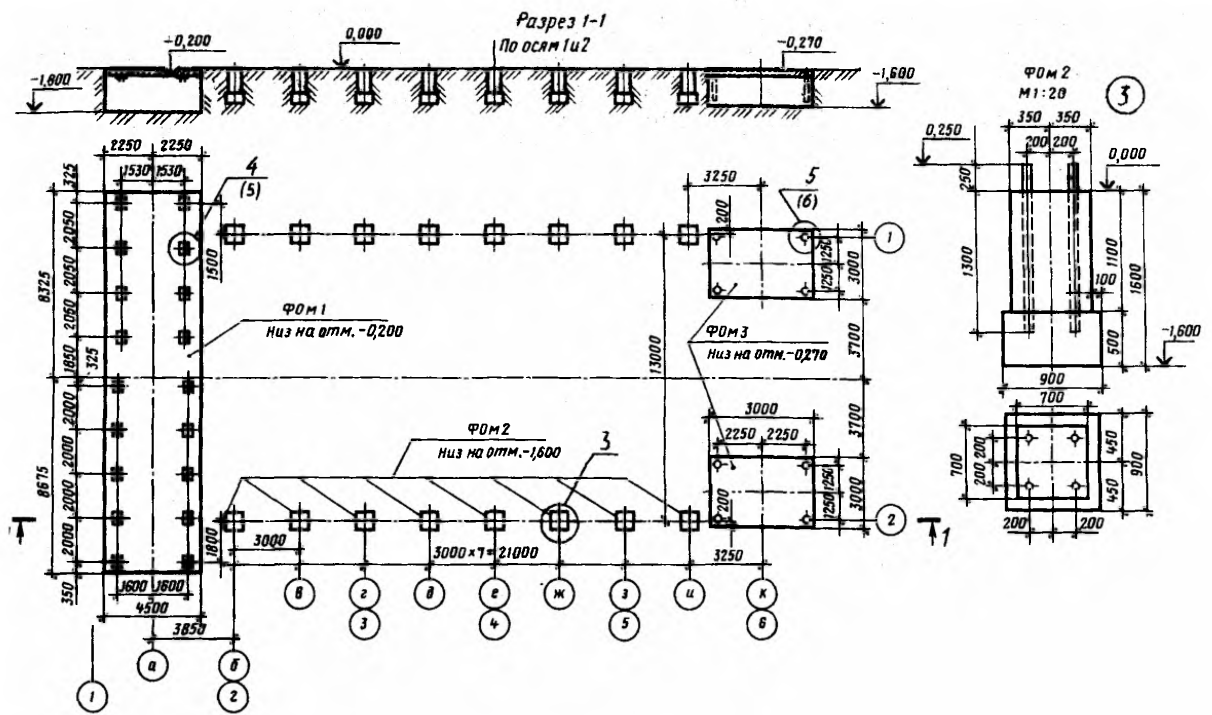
Монтажный чертеж плана фундаментов стана для сварки листовых конструкций
